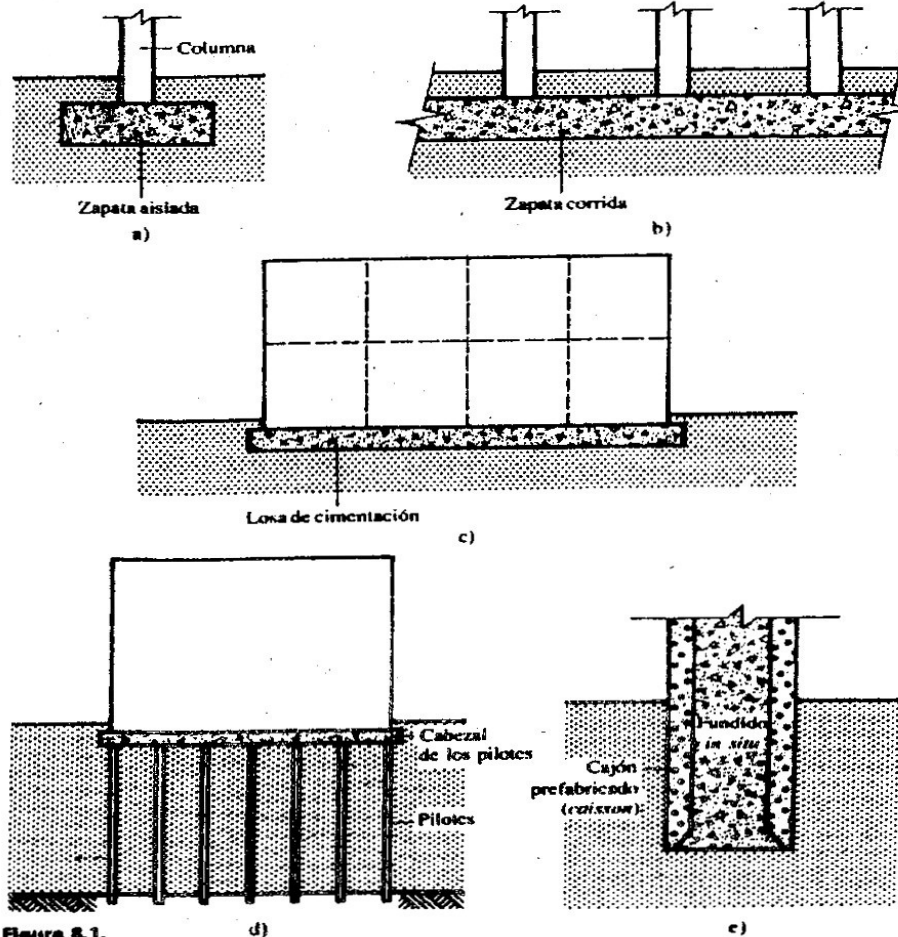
a) Zapata aislada o individual, b) zapata corrida o continua, c) losa de cimentación, d) cimentación sobre pilotes, e) pila de cimentación.
